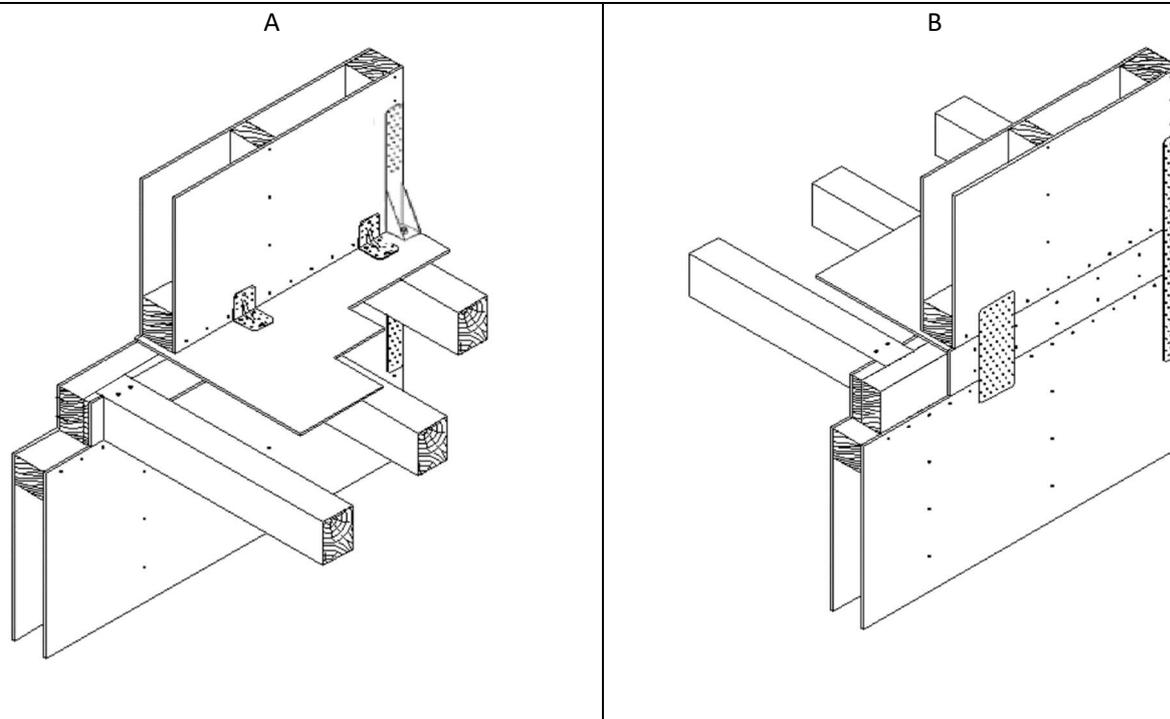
Soluzioni per il collegamento di interpiano. A collegamento per pareti esterne. B collegamento per pareti interne
